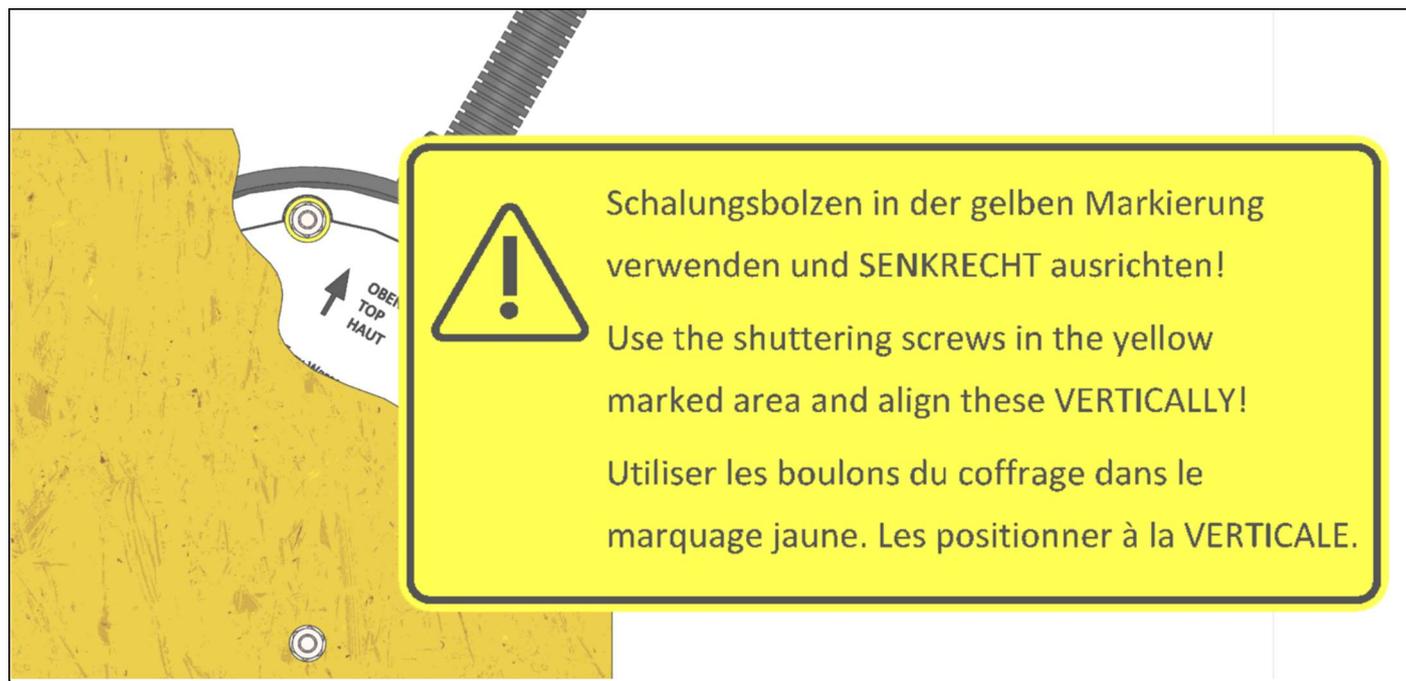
Remarque condition de montage bassin béton avec étanchéification au liner
